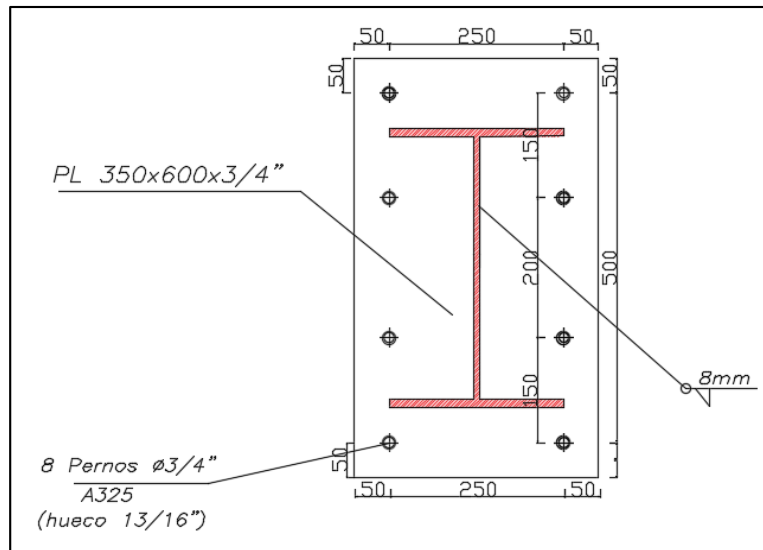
DETALLE DE CONEXIÓN A X=5 m EN PÓRTICOS DE ACERO
